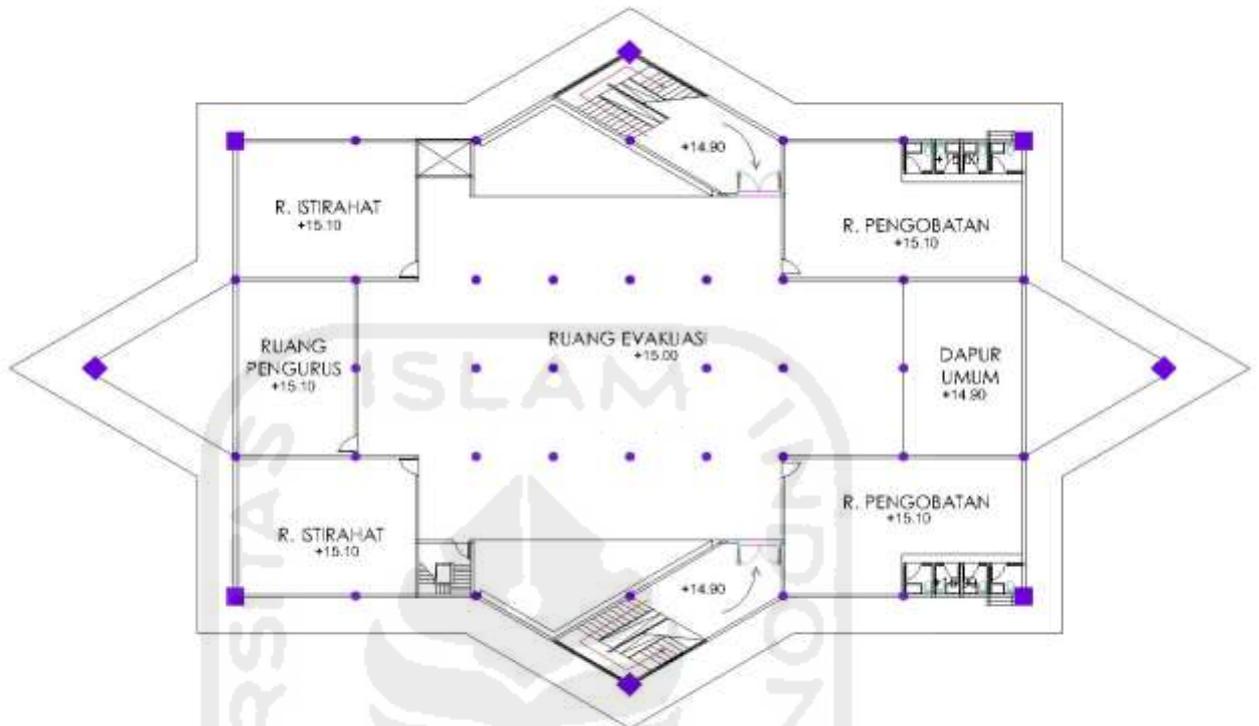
Denah Lantai 3 (Mezzanine)
